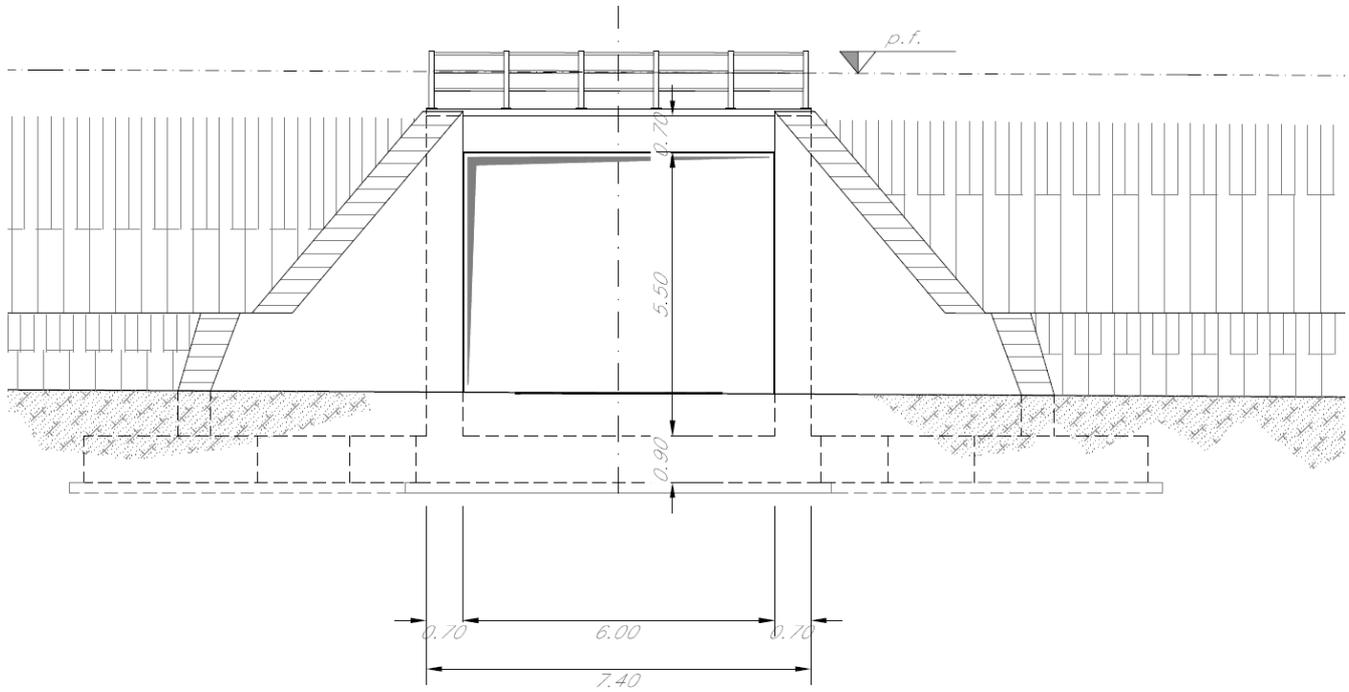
Sottovia scatolare SL07- prospetto trasversale
